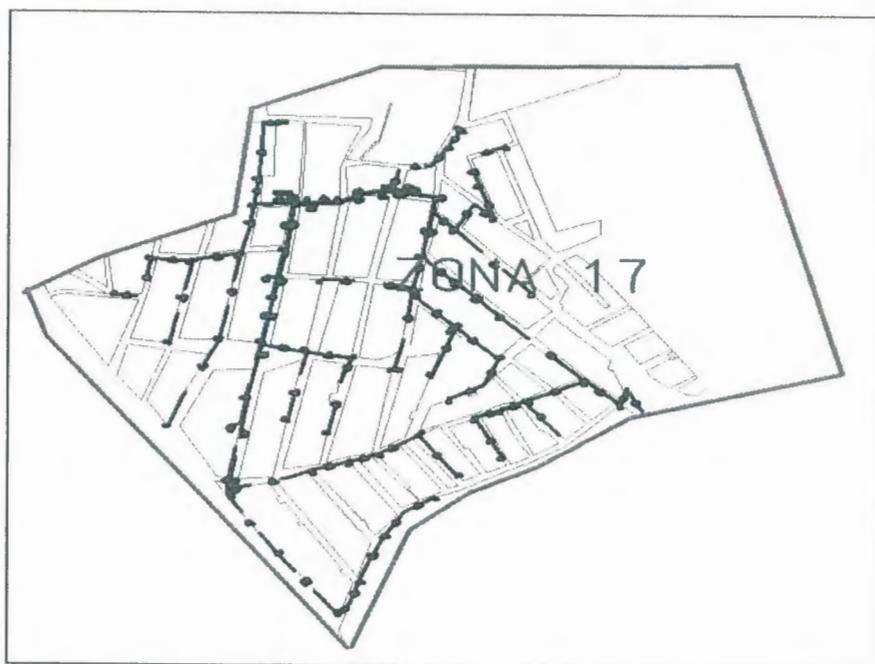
Planimetría zona 17 del sector de la vía a Daule
